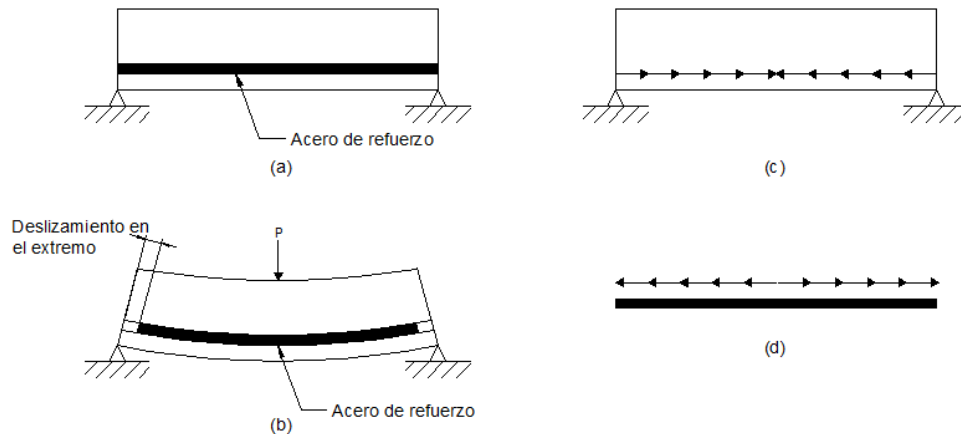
1 (a) Viga de hormigón armado antes de ser cargada; (b) deslizamiento del acero de refuerzo; (c) fuerzas de adherencia que actúan en el hormigón; (d) fuerzas de adherencia que actúan en el acero.
